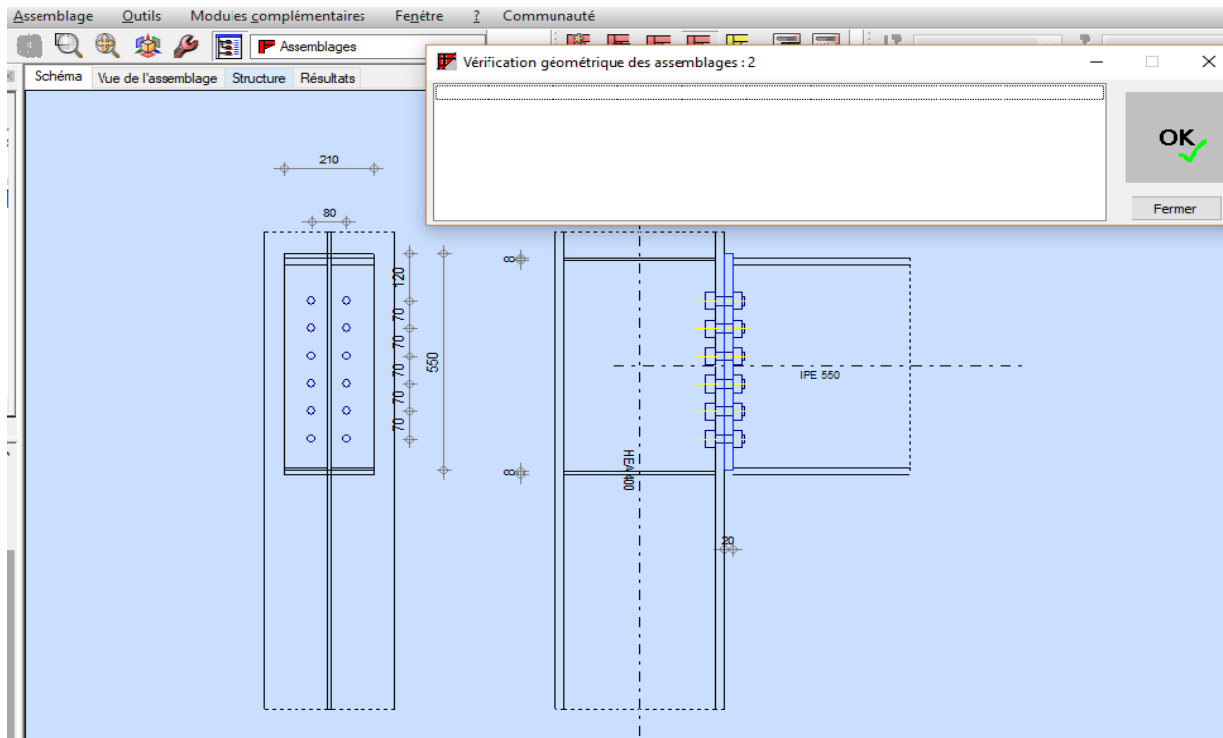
1 : Assemblage poteau-poutre (HEA400-IPE550)
